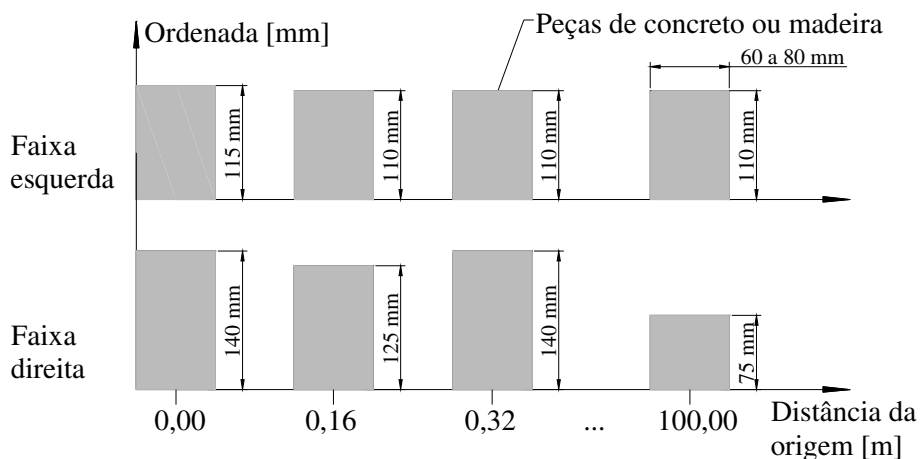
esquema construtivo da pista suave da ISO5008-1979.
